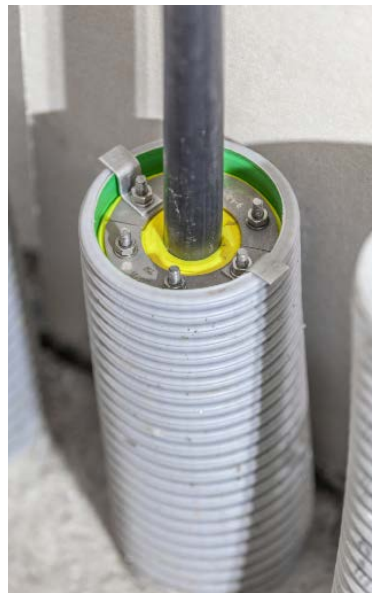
• Die Innendichtung Kabu-IN DD mit Segmentringtechnik sichert das Kabel passend für den jeweiligen Durchmesser gas- und druckwasser-dicht ab.
